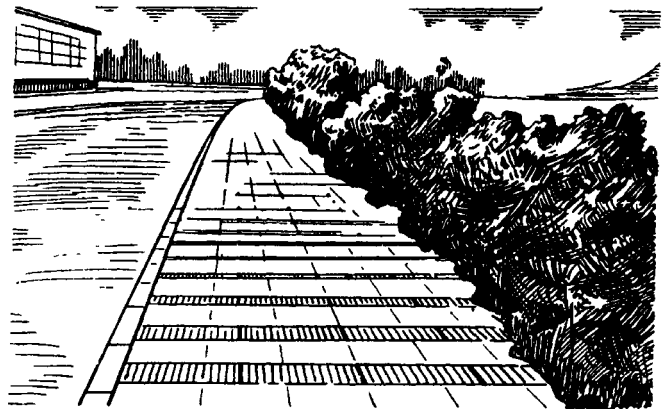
Тротуар со сборным покрытием из цементно-бетонных плит
